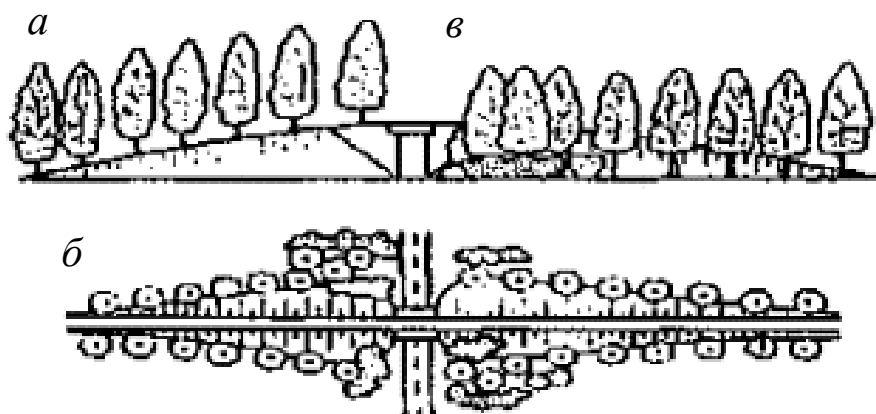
Декоративные посадки у насыпи на подходах к путепроводу:
